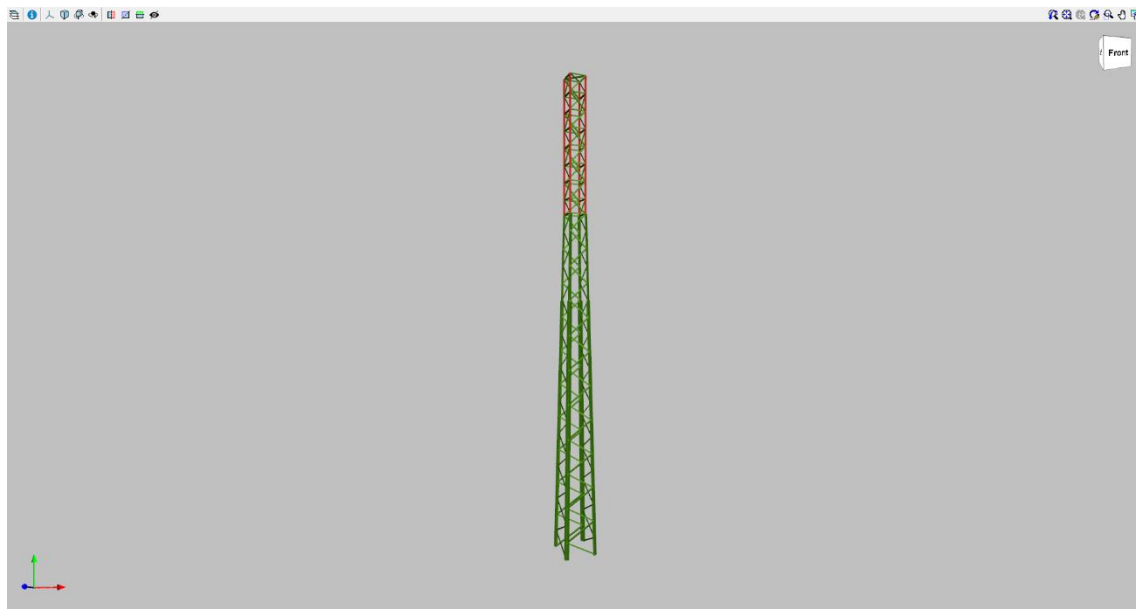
Renderizado de la antena en Cype (Fuente: Cype)
